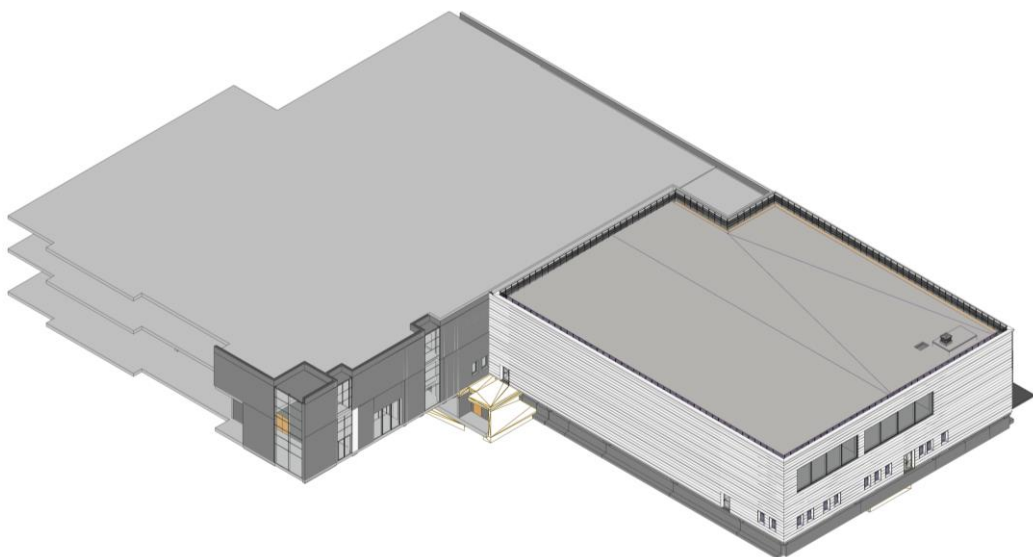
Vista 3D del modello, prospetto sud ovest/prospetto nord ovest
